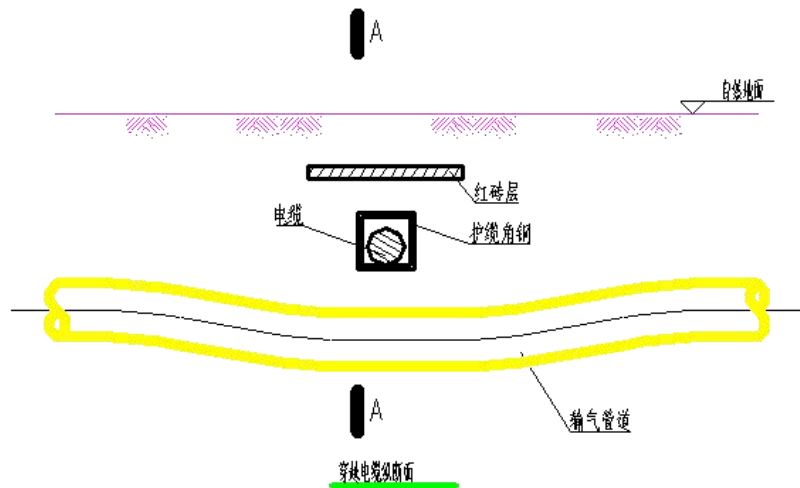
管道与光（电）缆交叉穿越断面示意图
